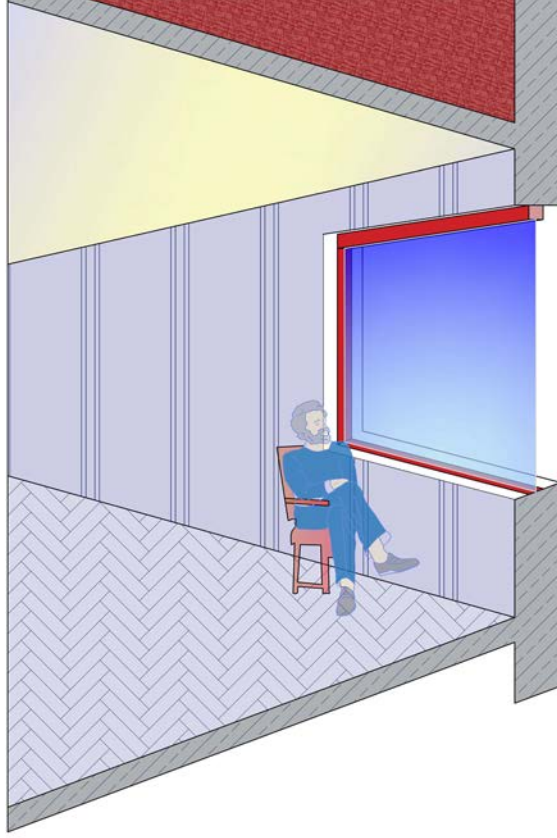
Geniş görüşe sahip mahal (parapet yok)
